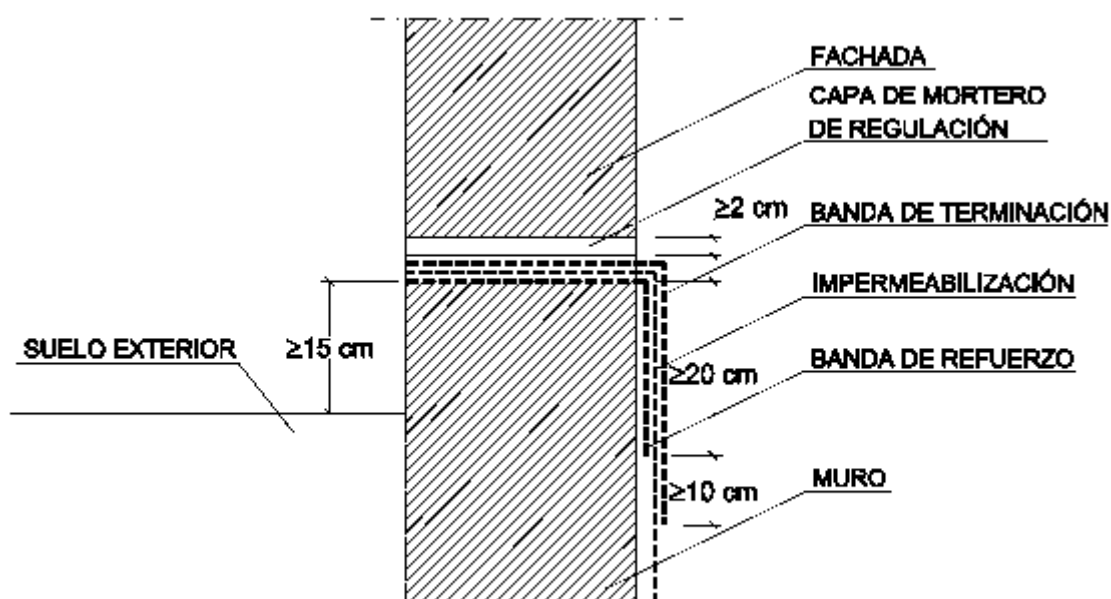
Ejemplo de encuentro de un muro impermeabilizado por el interior con lámina con una fachada
